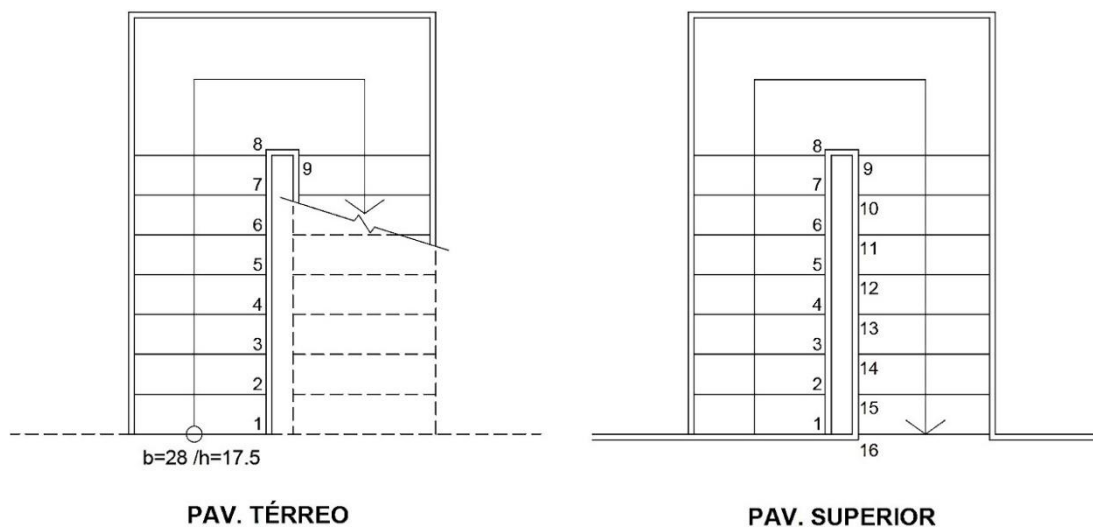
Diferenciação de representação da escada nas plantas baixas do pavimento térreo e segundo pavimento. Fonte: autor
